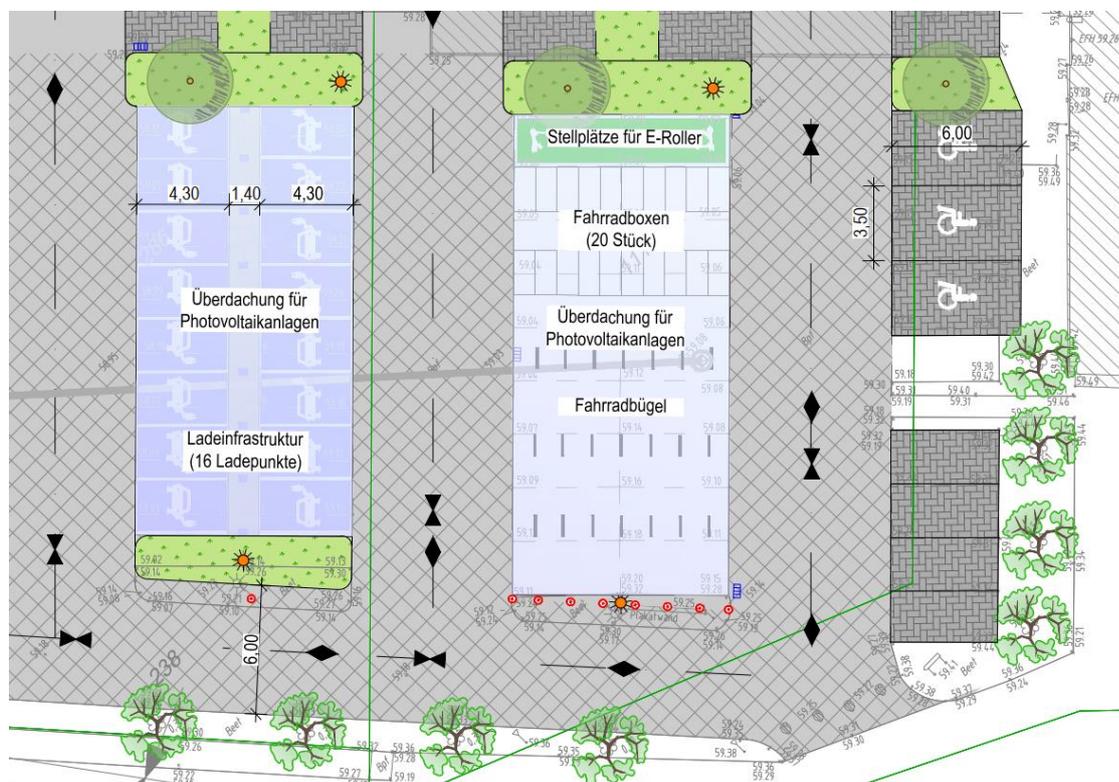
Lageplanausschnitt Behindertenstellplätze, Fahrradstellplätze und Ladeinfrastruktur
